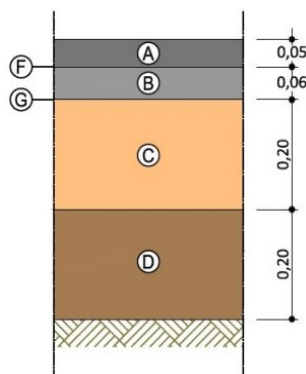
Pormenor do pavimento Tipo II – Faixa de Rodagem
